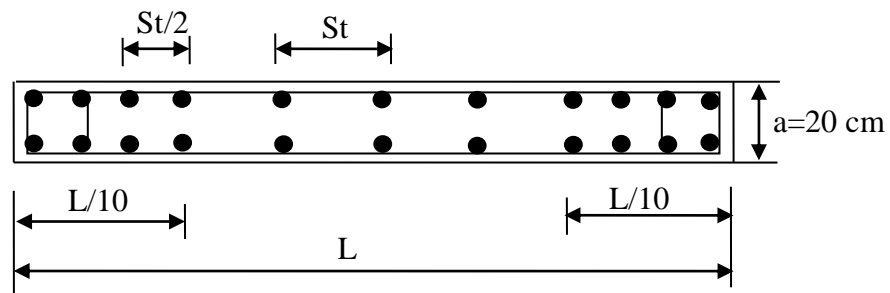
Disposition des armatures verticales dans les voiles.
